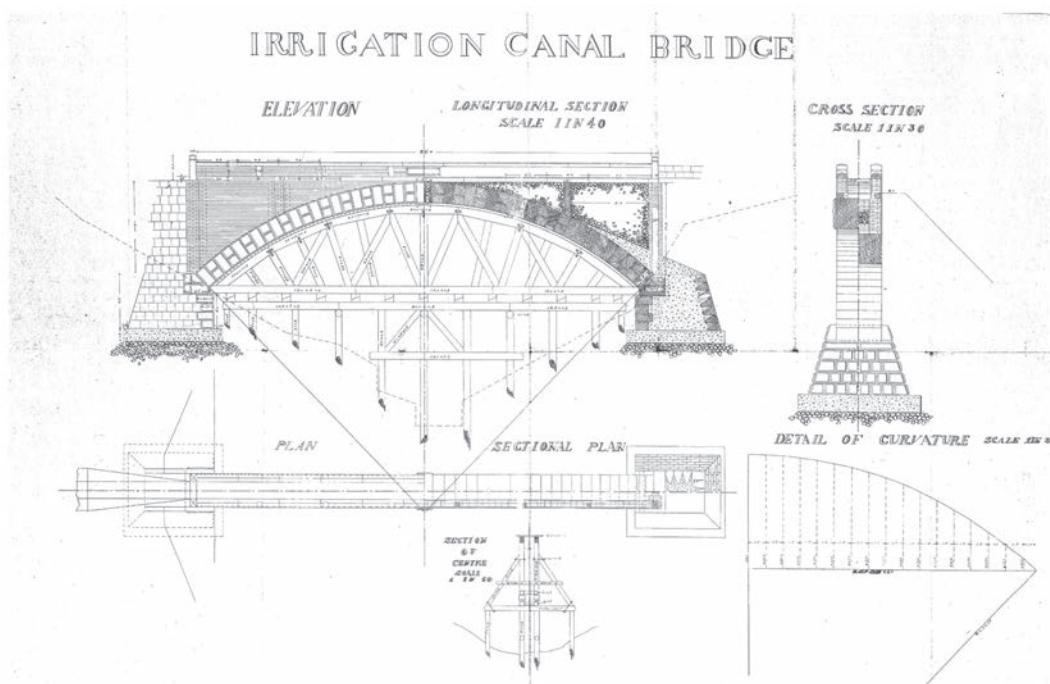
当初の設計図『IRRIGATION CANAL BRIDGE』
